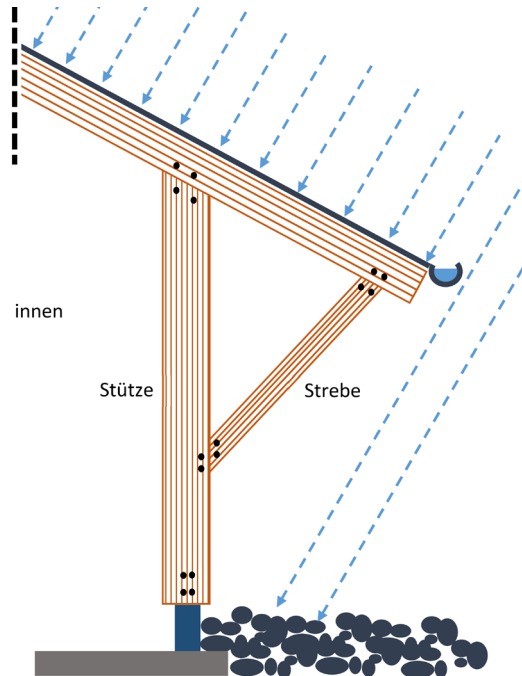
Vertikalschnitt durch Hallenlängswand mit abgestrebtem Dachüberstand
